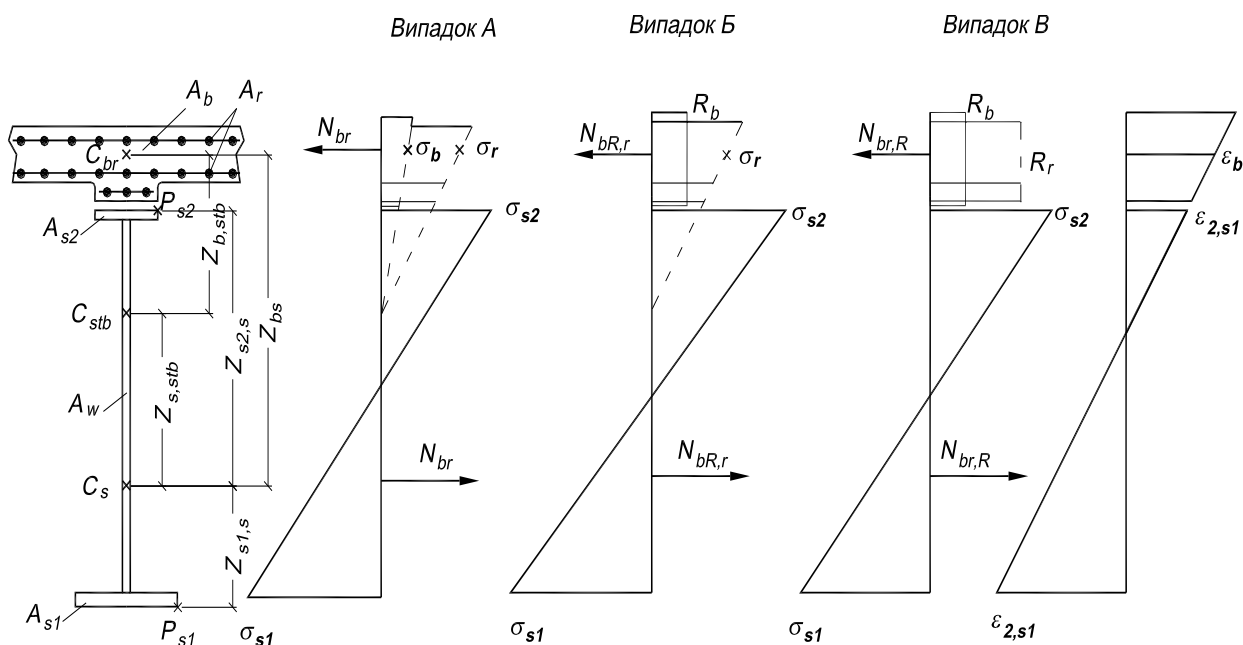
Розрахункові випадки розподілу напружень і деформацій у нормальному сталезалізобетонному перерізі при наявності додатнього згинального моменту
